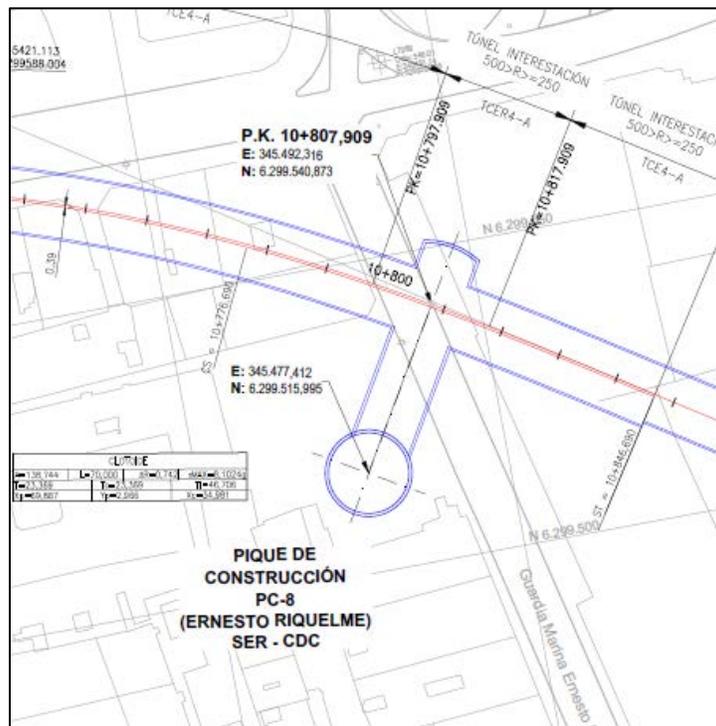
Planta Emplazamiento Pique Construcción Ernesto Riquelme
